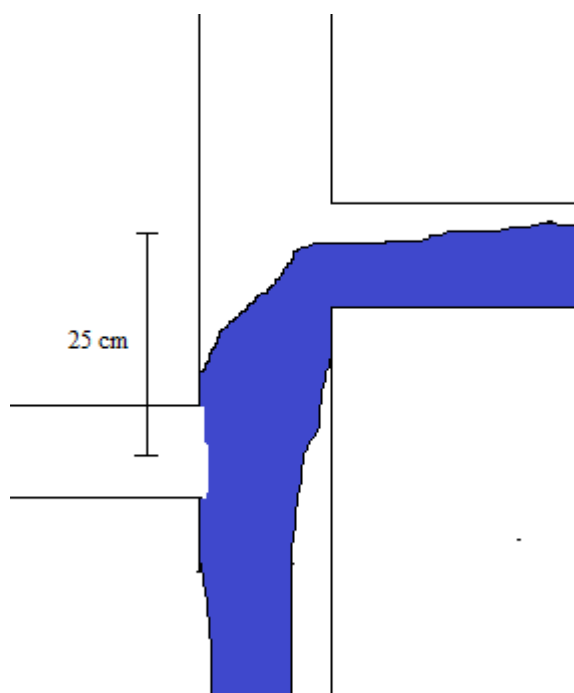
Proposta de disposição construtiva – Exemplo ligação em T
